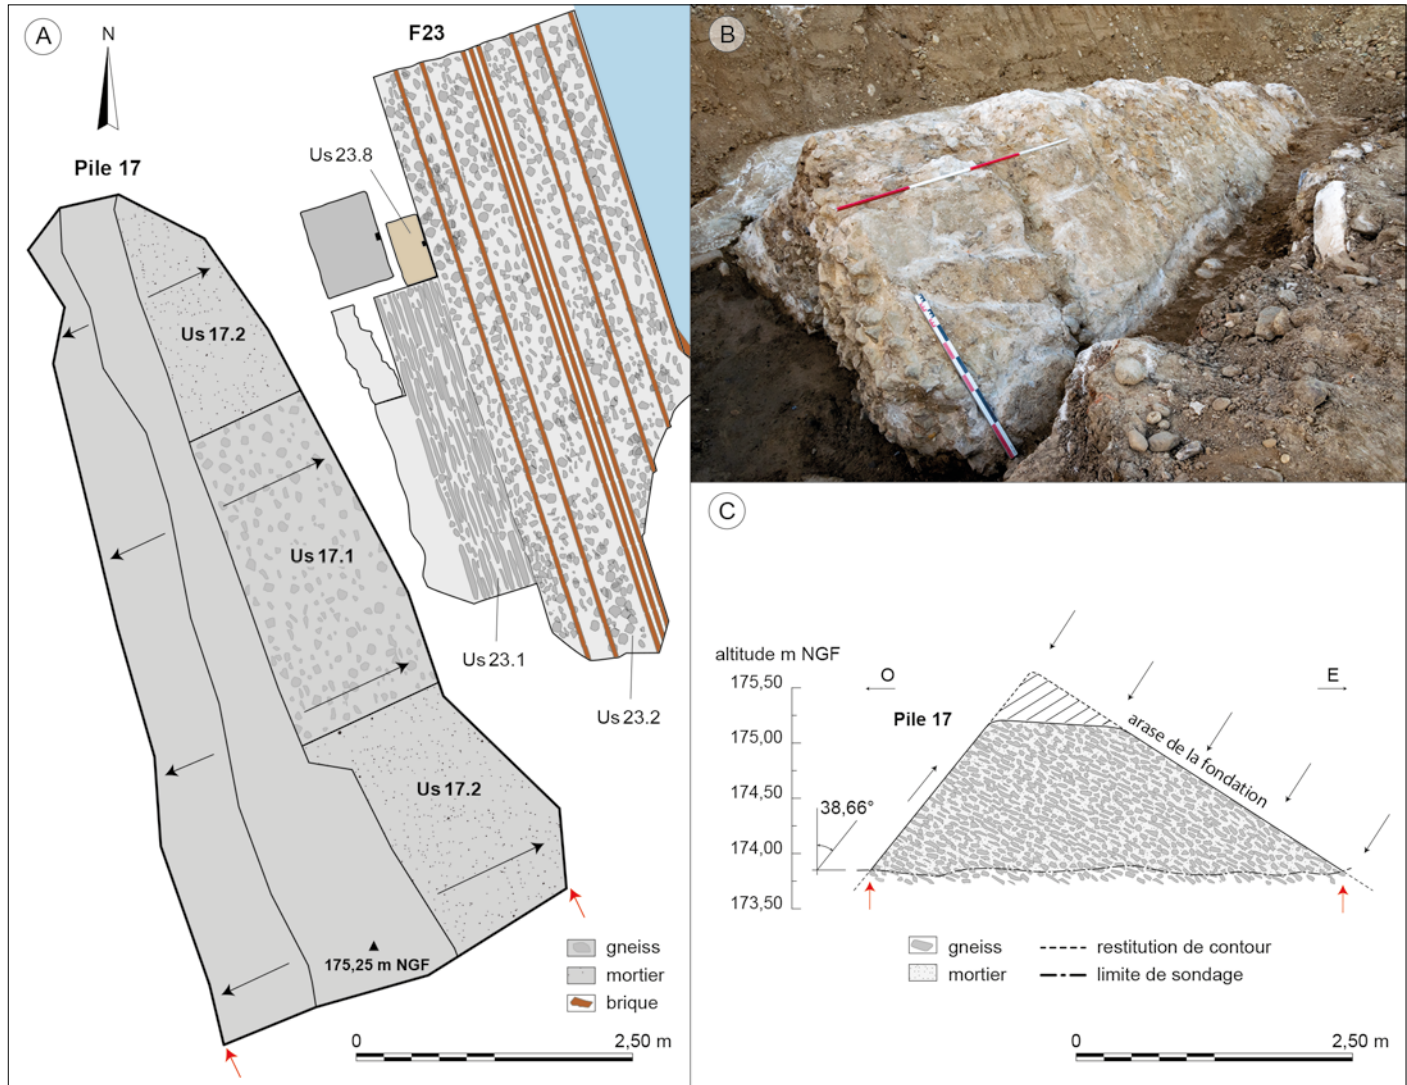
Pile 17 du pont-siphon de Beaunant à Sainte-Foy-lès-Lyon: A, détail du plan de la pile et du fragment de maçonnerie effondré F23; B, vue vers le nord-ouest du massif de fondation; C, profil du massif de fondation (cliché et DAO: D. Baldassari).
